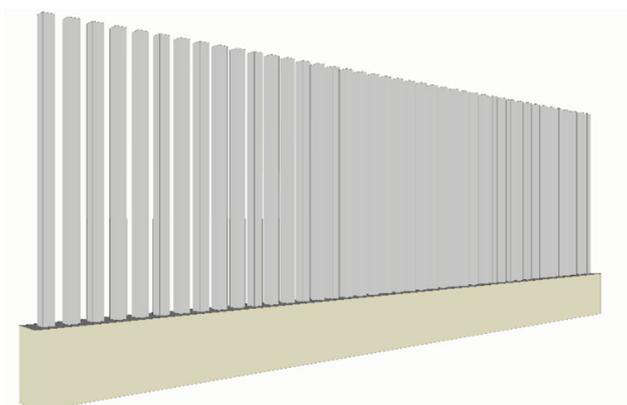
Vista prospettica della recinzione della SSE utente di trasformazione
